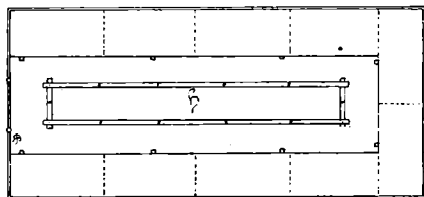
Grundriss einer Holzknechthütte im steirischen Wechselgebiet.
